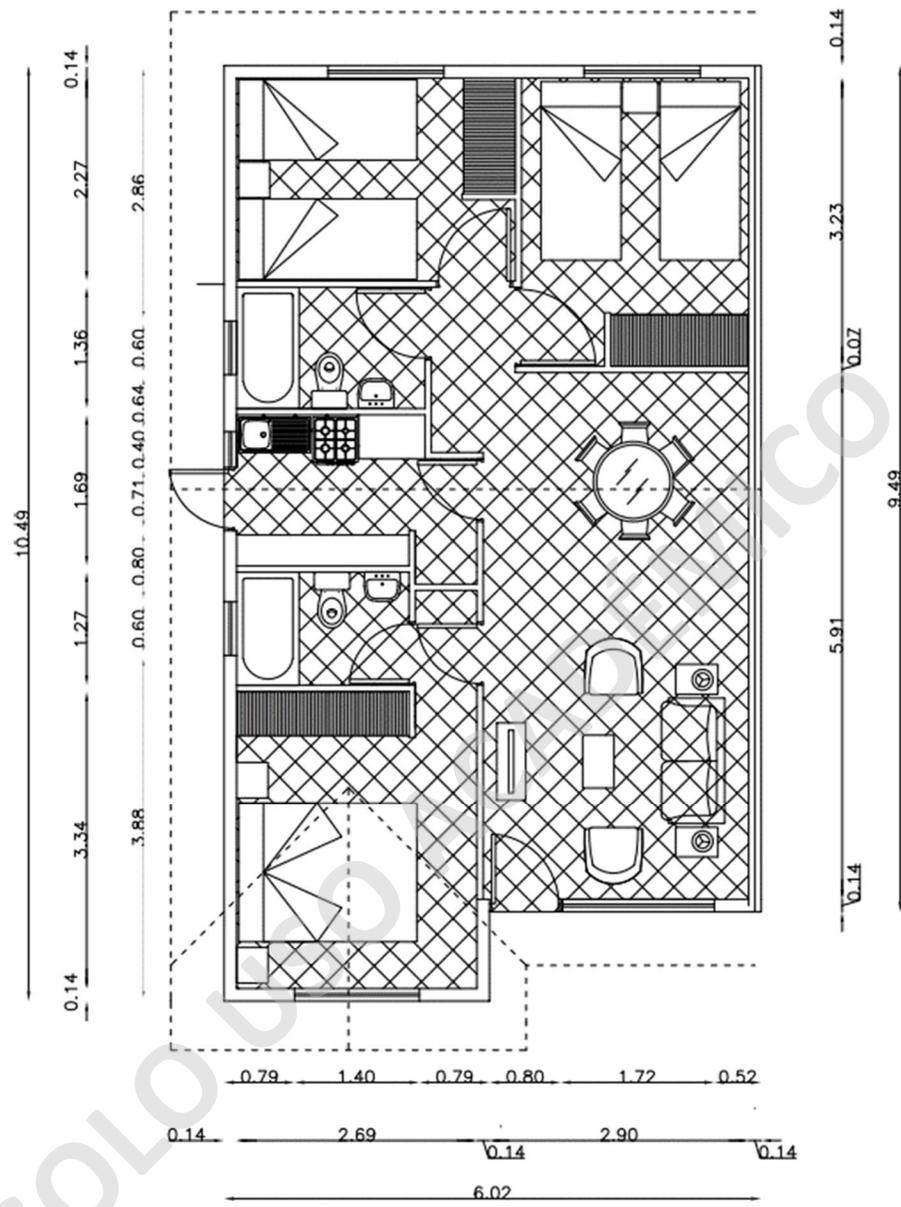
Plano de planta Vivienda propuesta - Fuente elaboración propia.
